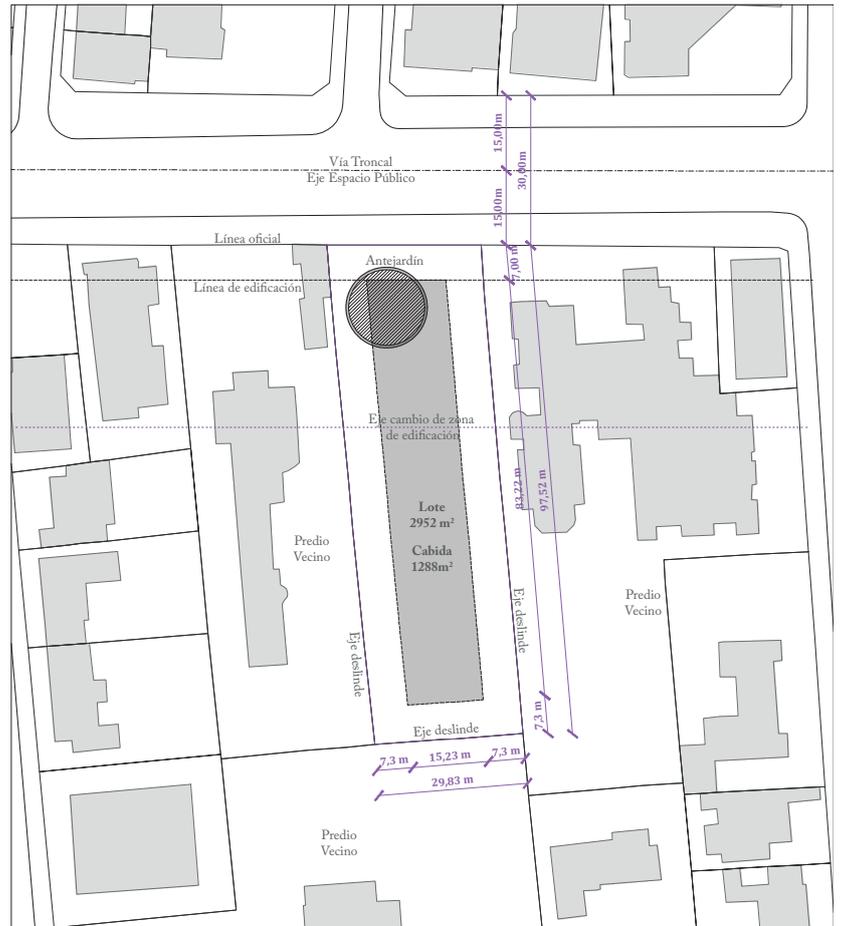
Planta volumen teórico. Esc. ≈ 1:1500. Fuente: Elaboración propia.
